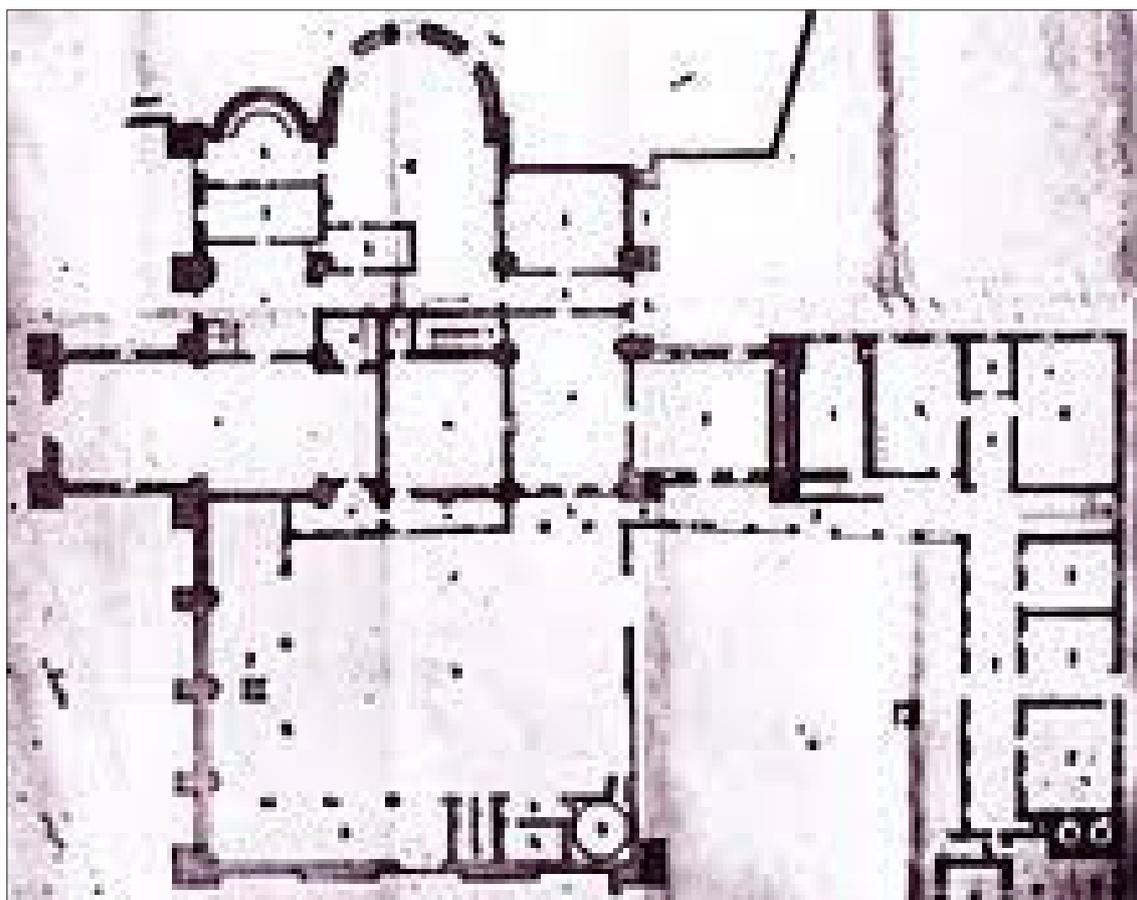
Planimetria di Santa Maria (disegno ing. Pavese, 1812).
